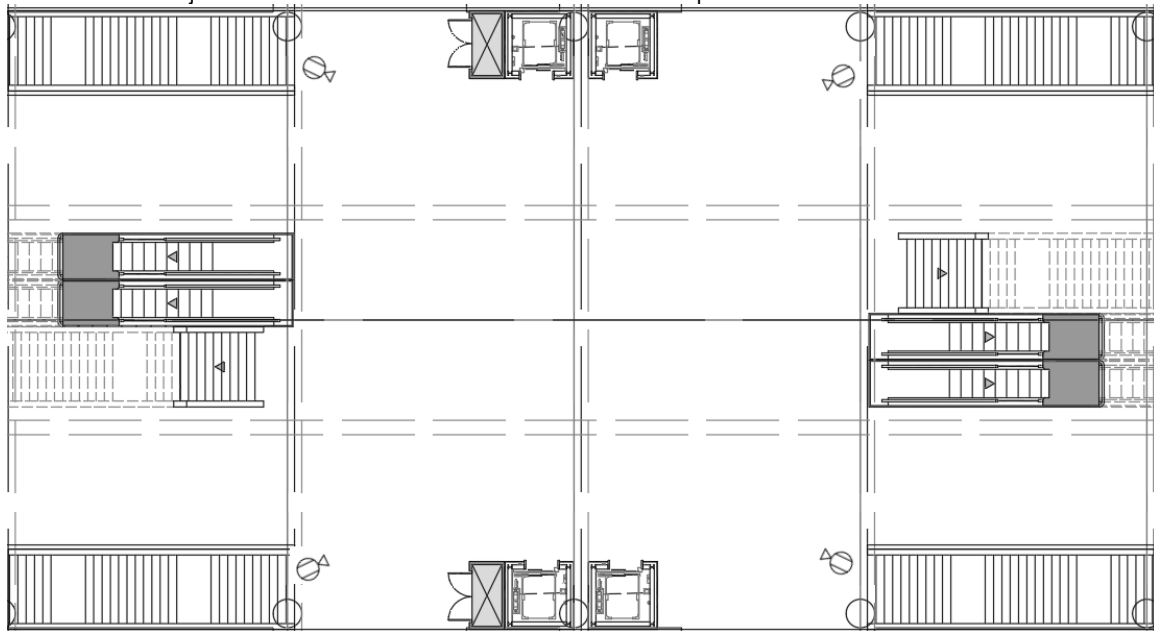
Sistema CCTV ascensores Planta 3 Estación típica
